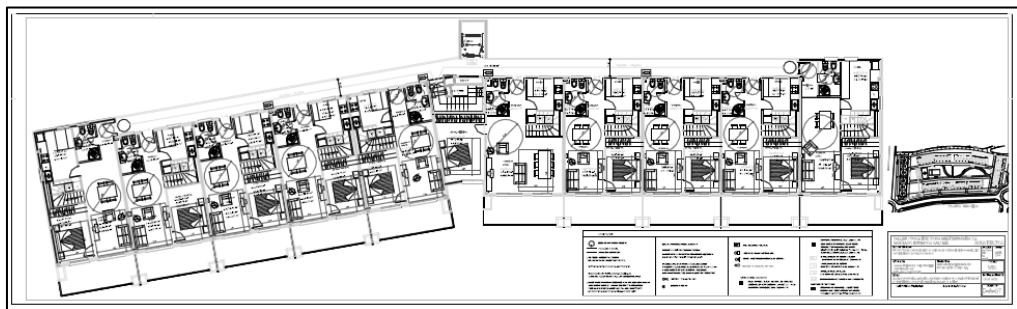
Juntas 12, 13 y 14 - Planta Segunda. Fuente propia
